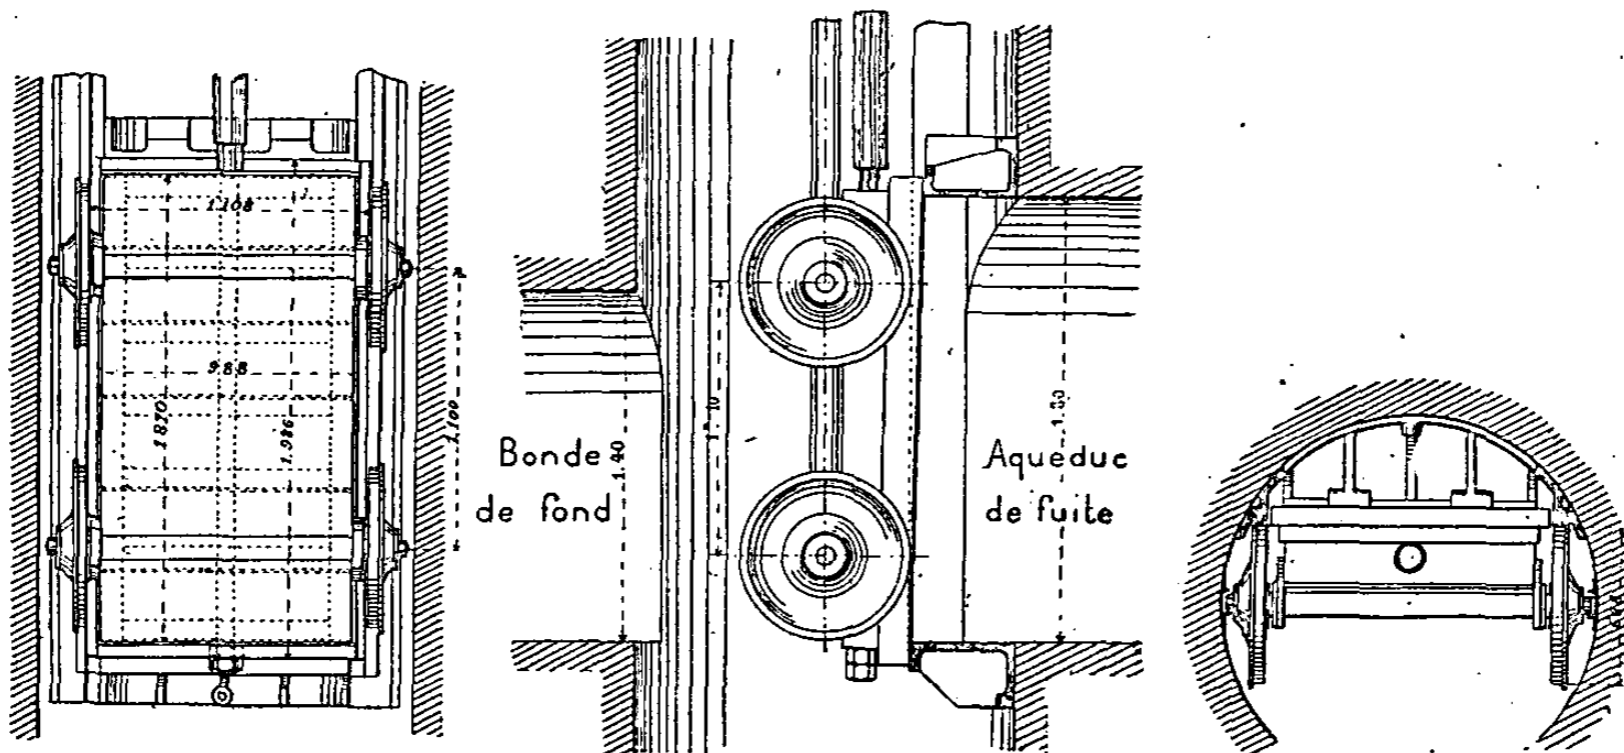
à 157. — Elevation, coupe et plan de la vanne de garde.
